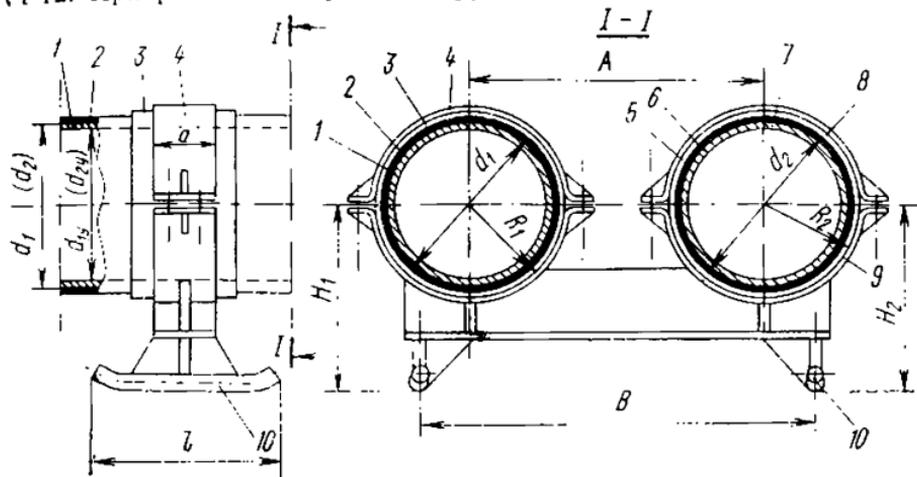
Опора для размещения двух газопроводов в футляре
